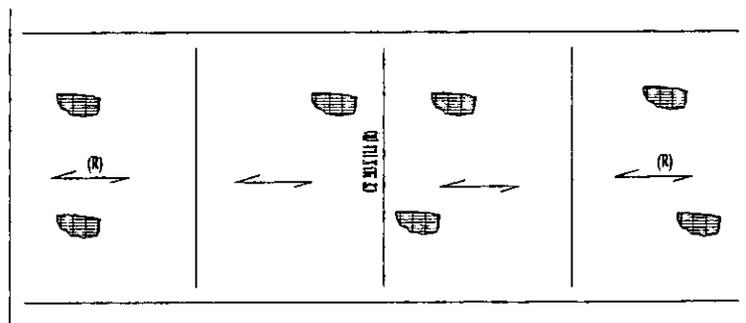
REJILLA Y VIGA, REMOVIBLES
